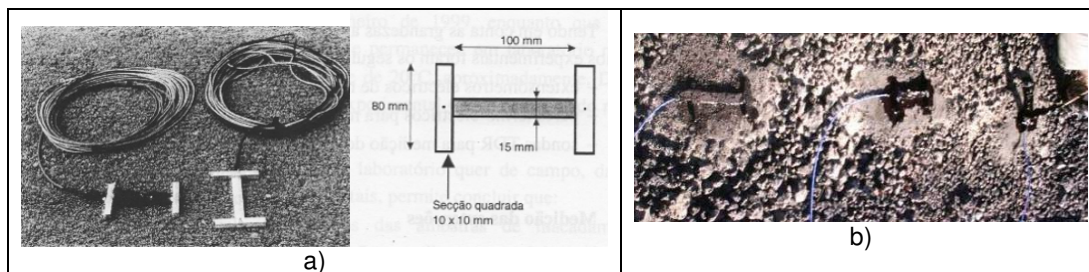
a) Extensómetros horizontais (transversais e longitudinais); b) Colocação na camada
